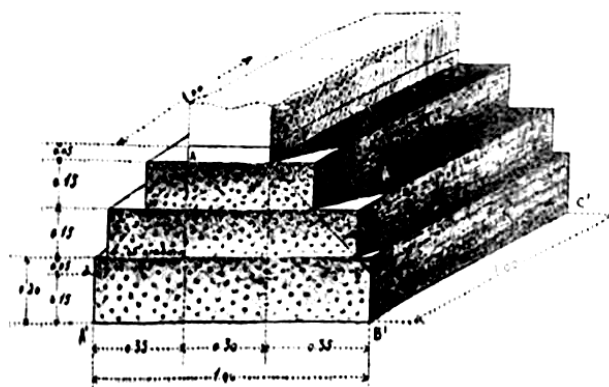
Tipo de cimentación en masa en tronco de pirámide (Jalvo, 1903)
